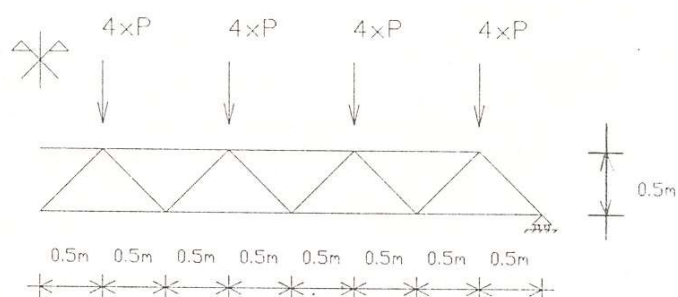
Vista em alçado da cobertura metálica tridimensional
